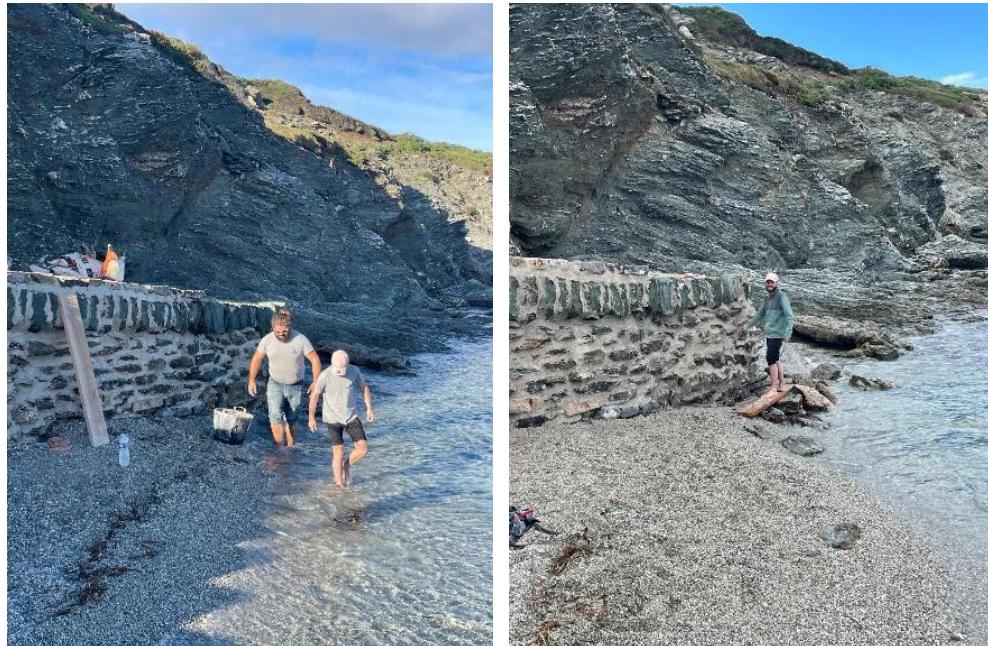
Travaux sur le mur en pierre de l'embarcadère de l'île du Grand Rouveau.
